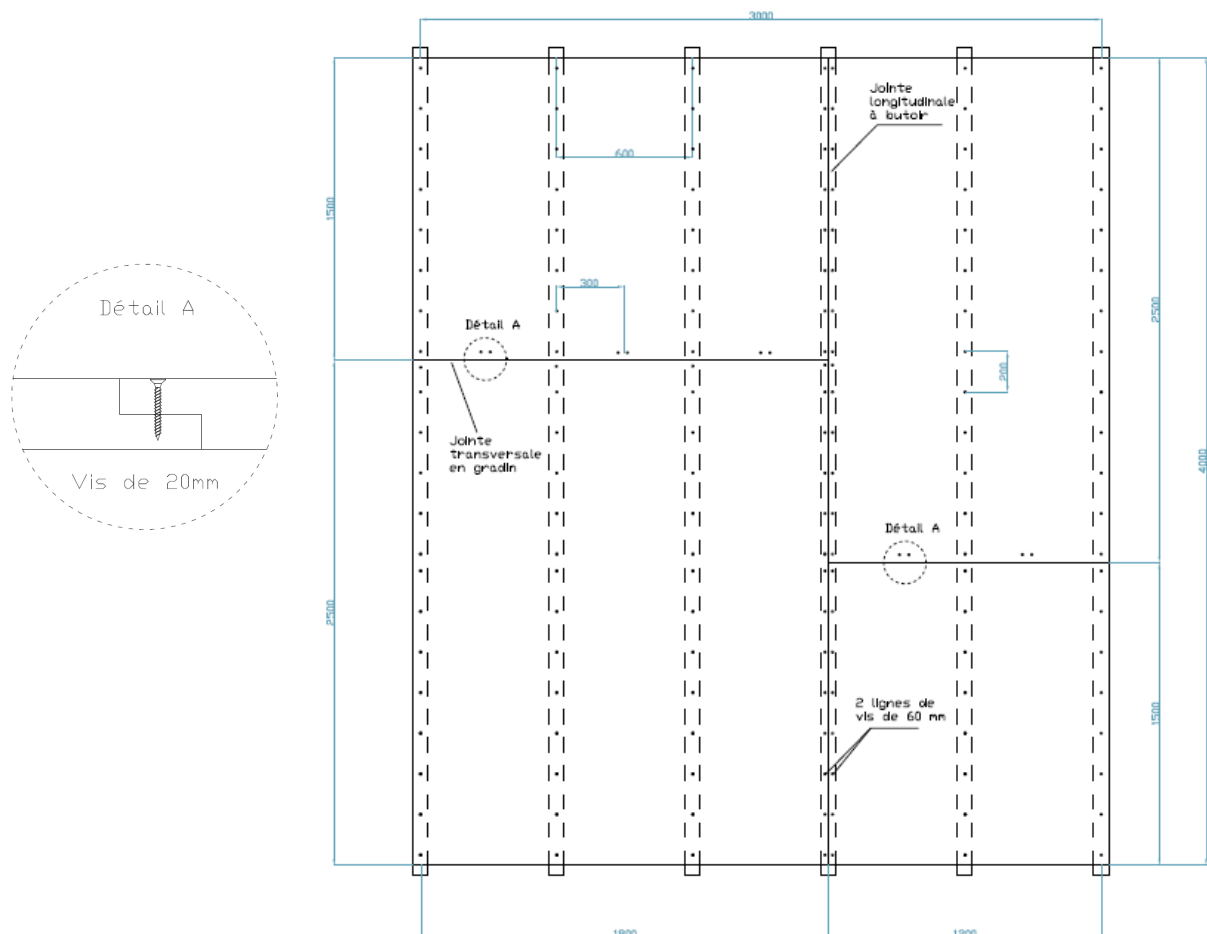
Disposition des poutres en bois, des lambourdes entre les panneaux et des fixations mécaniques.
